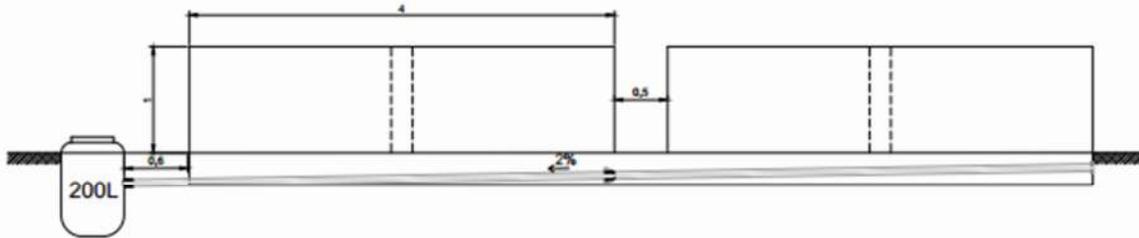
Planta de Locação e Planta das Leiras de compostagem.
